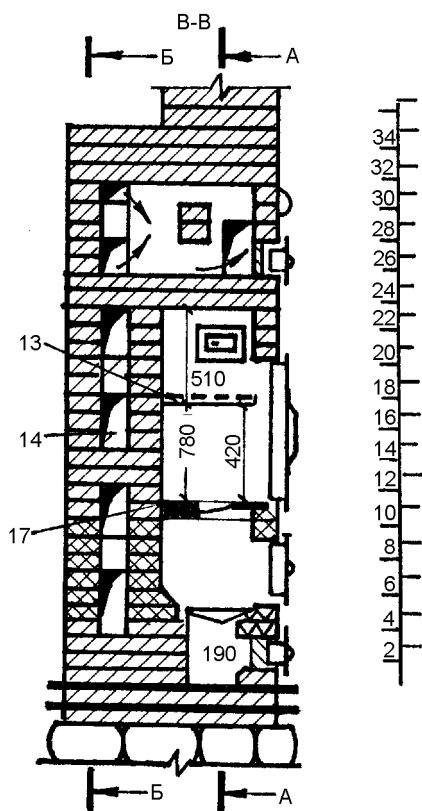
Устройство отопительно-варочной печи И.Ф. Волкова без камеры для выпечки хлеба
